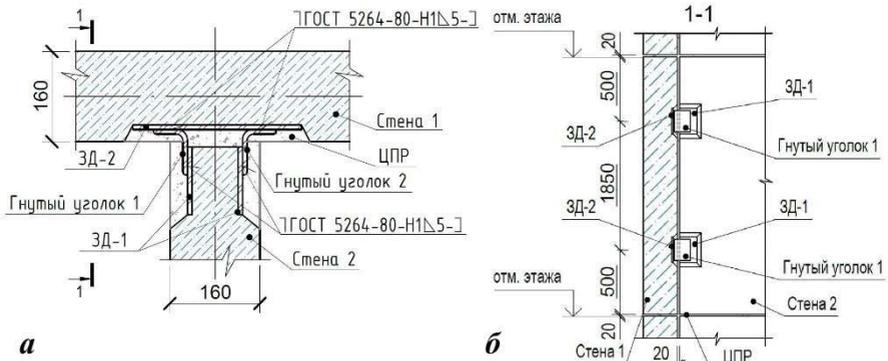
Сварной вертикальный стык на закладных деталях с гнутыми уголками (а), сварной вертикальный стык на закладных деталях с гнутыми уголками в пределах этажа (б)
